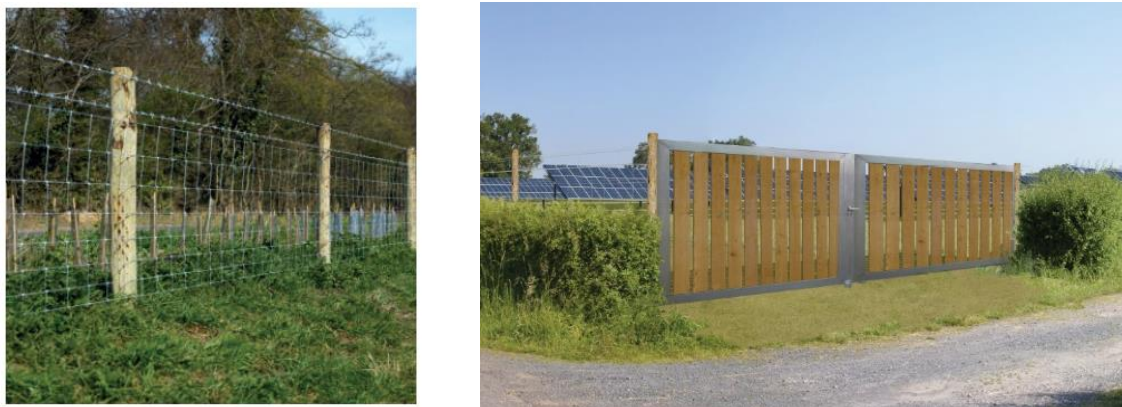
Exemple de grillage et portail d'accès (Source : Actif Solaire)
